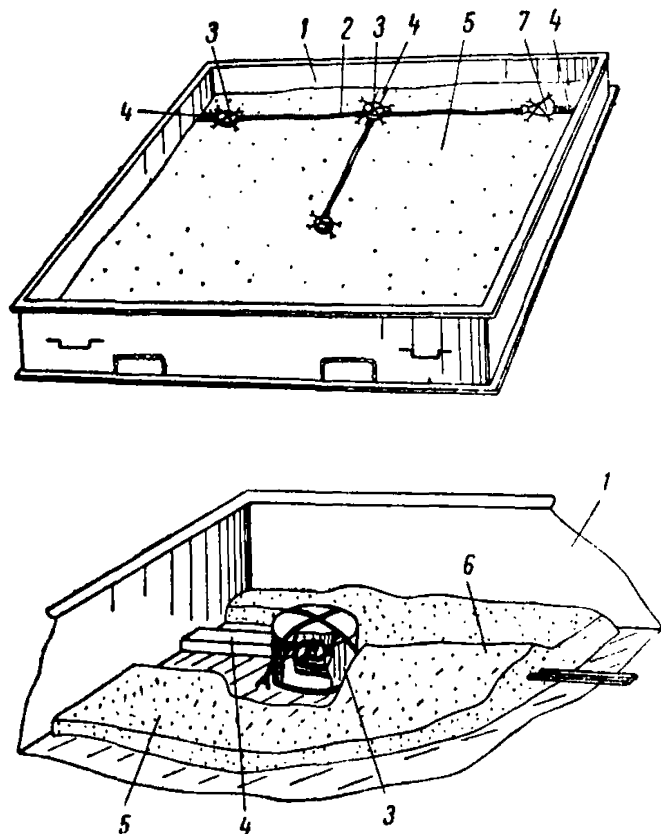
Замоноличивание электропроводки в стеновую шлакобетонную панель, изготовляемую в горизонтальной форме
